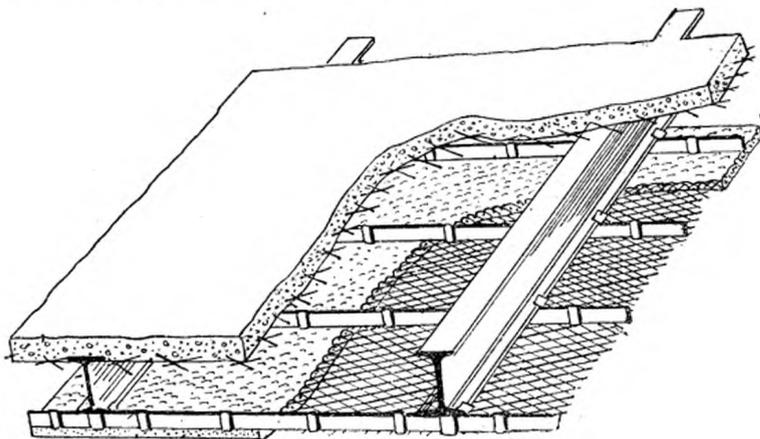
Plafond plâtré sur lattis de *Métal Déployé* suspendu sous un plancher en béton, avec l'espace pour la circulation de l'air.
